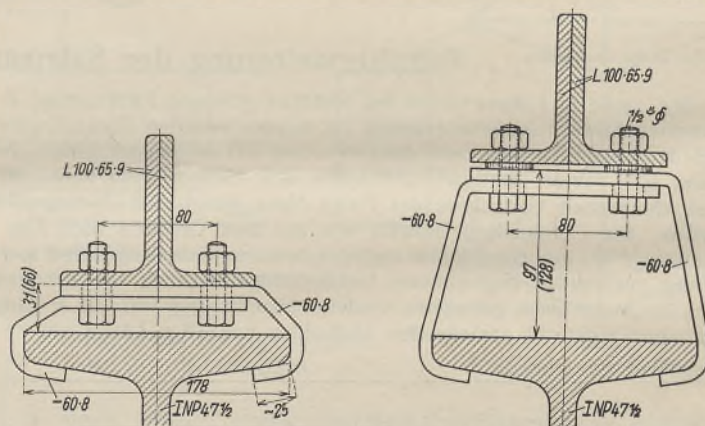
Klammernbefestigung der neuen Fußbodenkonstruktion.
